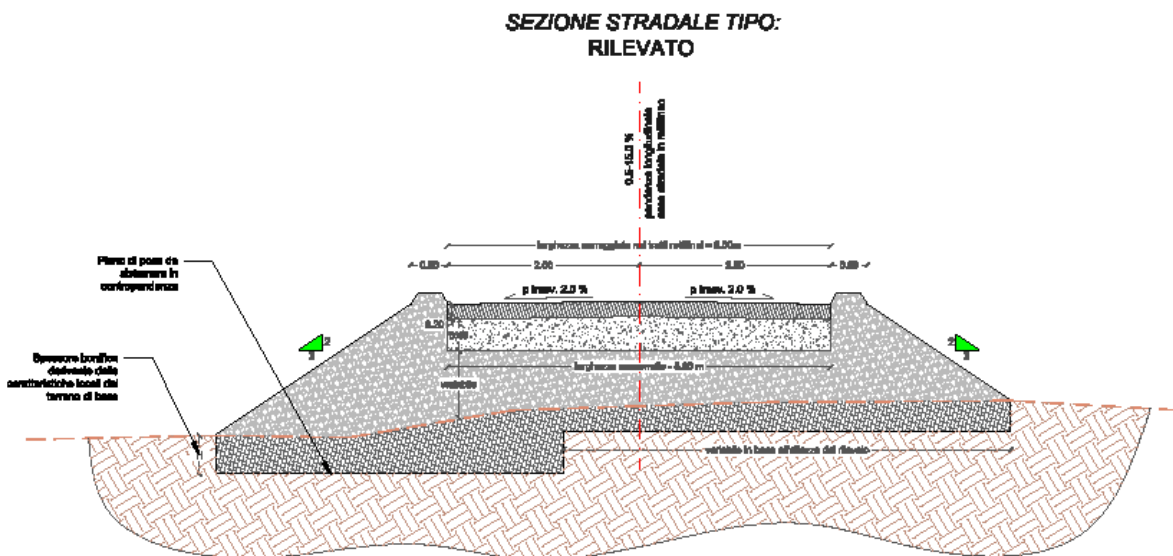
Sezione stradale tipo in rilevato all'interno del parco eolico
